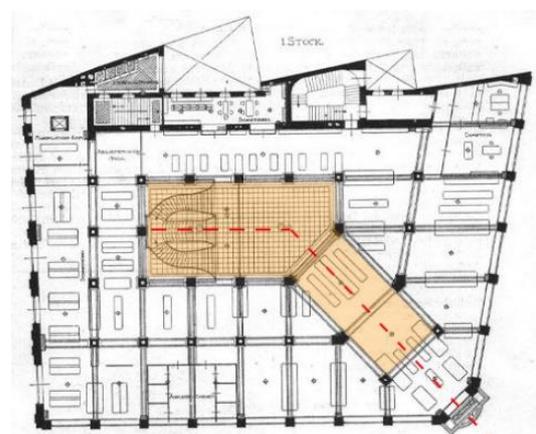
Grundriss 1. Obergeschoss,
